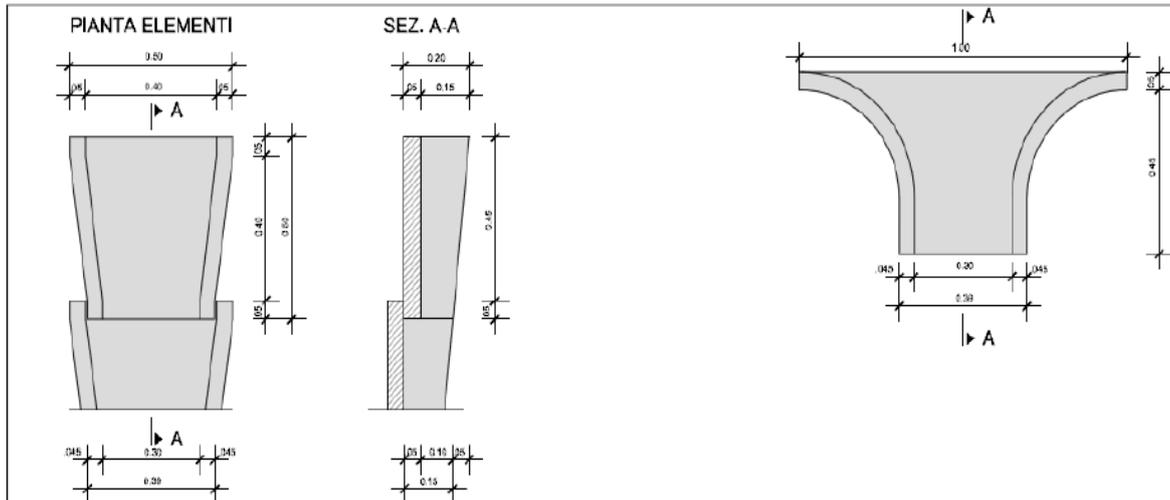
Dettaglio degli embrici in pianta e in sezione
